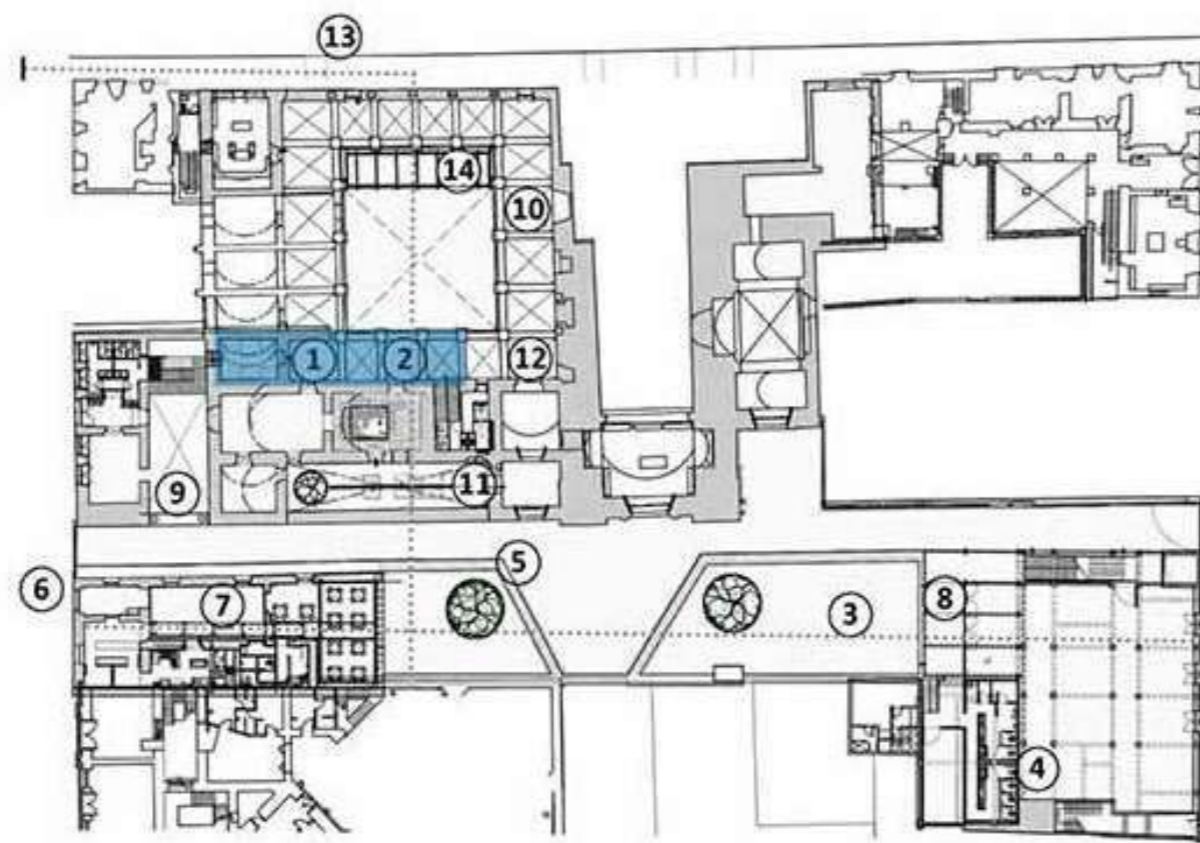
Planta arquitectónica de intervención. Elaboración propia
